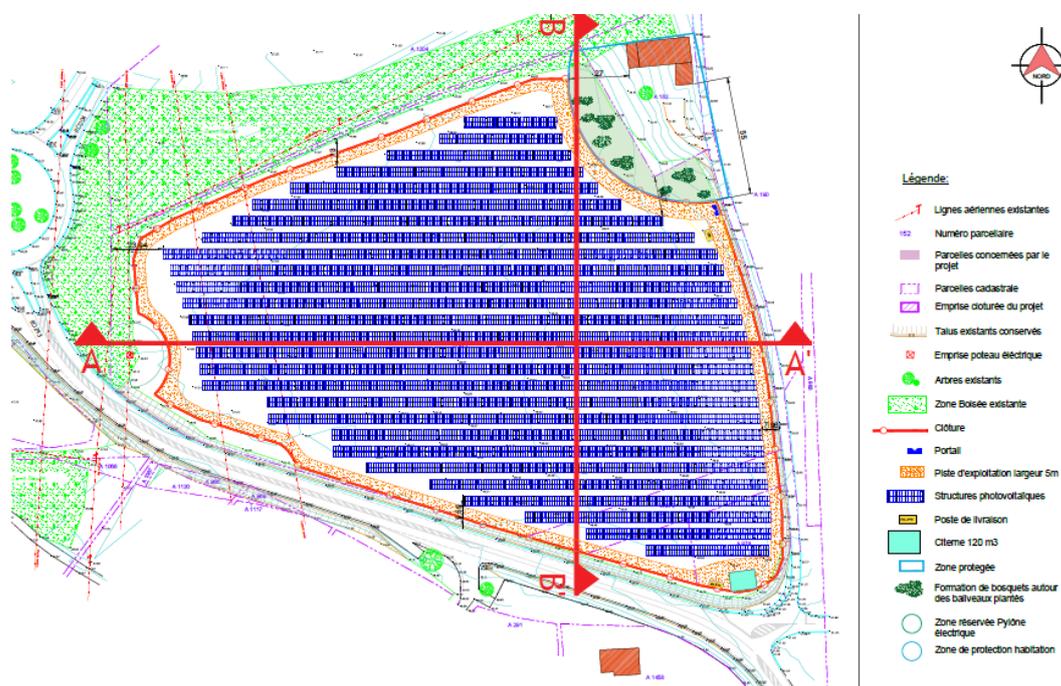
Plan de masse du projet. Source: dossier de permis de construire.
